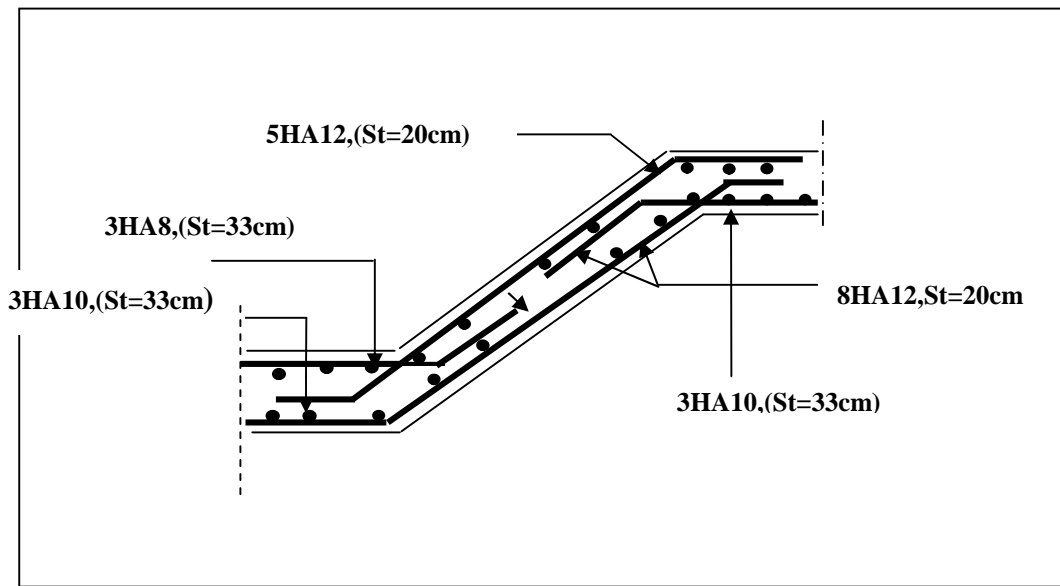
Schéma d ferrailage de tronçonne DE de l'escalier de type III
